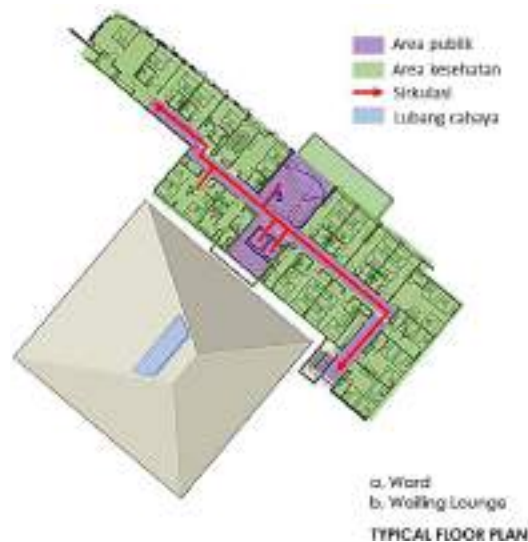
Denah Lantai Dasar Kemang Medical Care (archdaily.com)
